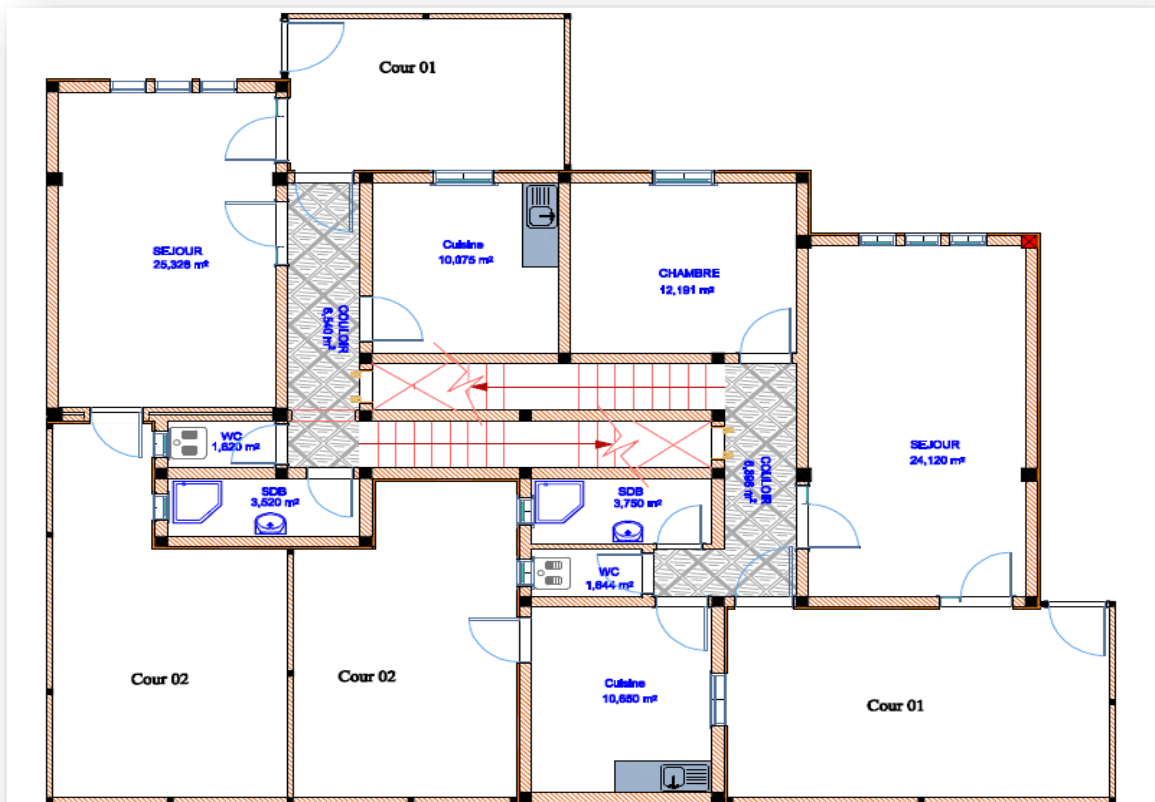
VUE EN PLAN DU RDC REALISE PAR AUTOCAD
